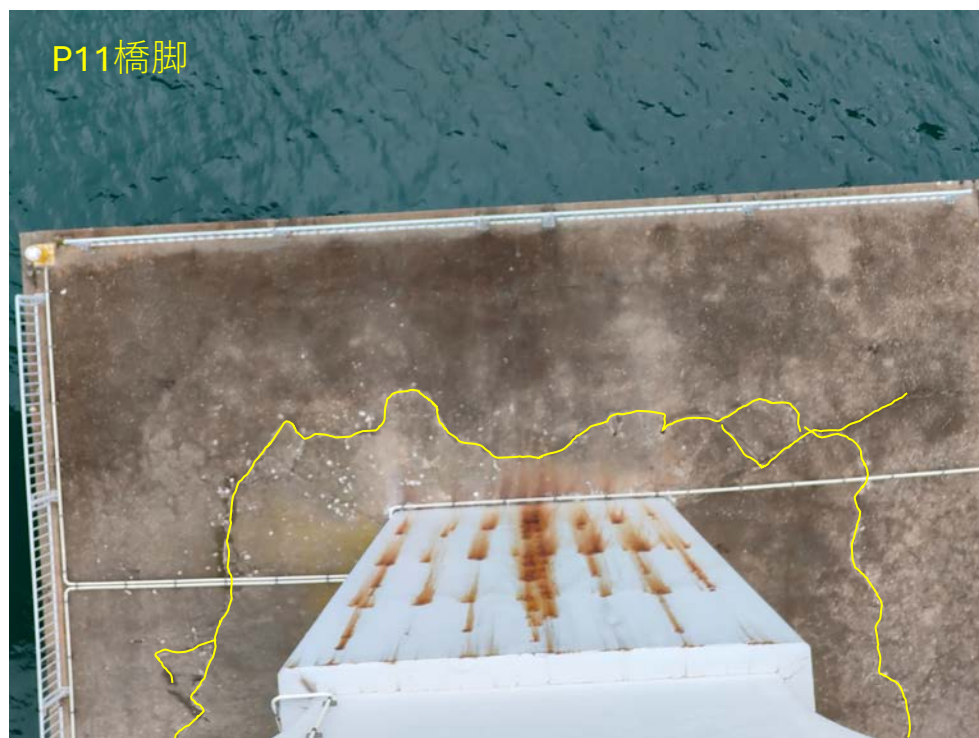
P11 橋脚のフーチング上面のひび割れ
